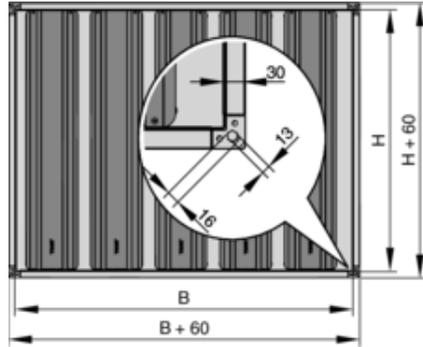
Silencieux à baffles avec profil de conduit d'air de 30 mm (P)
